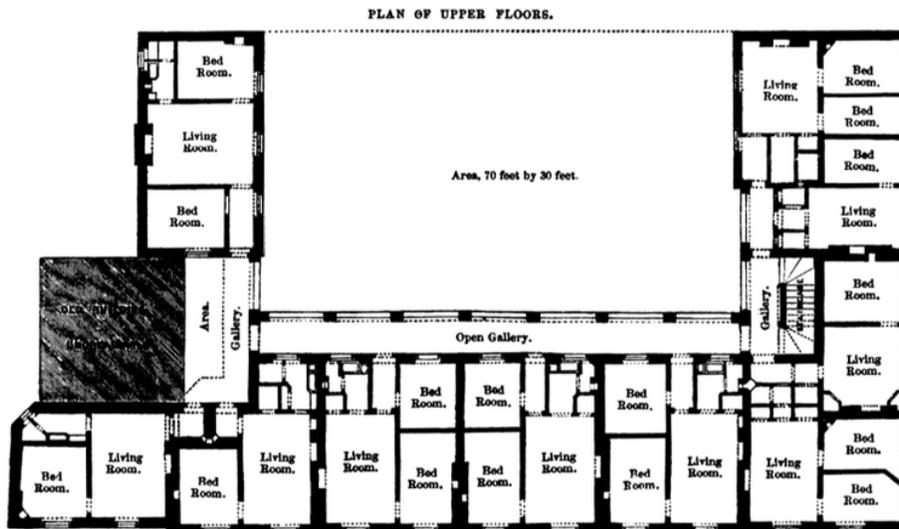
Planta tipo del Lofty-Pyle en Streatham Street. Fuente: [https://www.researchgate.net/figure/Figura-1-Planta-tipo-del-Lofty-Pyle-en-Streatham-Street\\_fig1\\_334706340](https://www.researchgate.net/figure/Figura-1-Planta-tipo-del-Lofty-Pyle-en-Streatham-Street_fig1_334706340)
